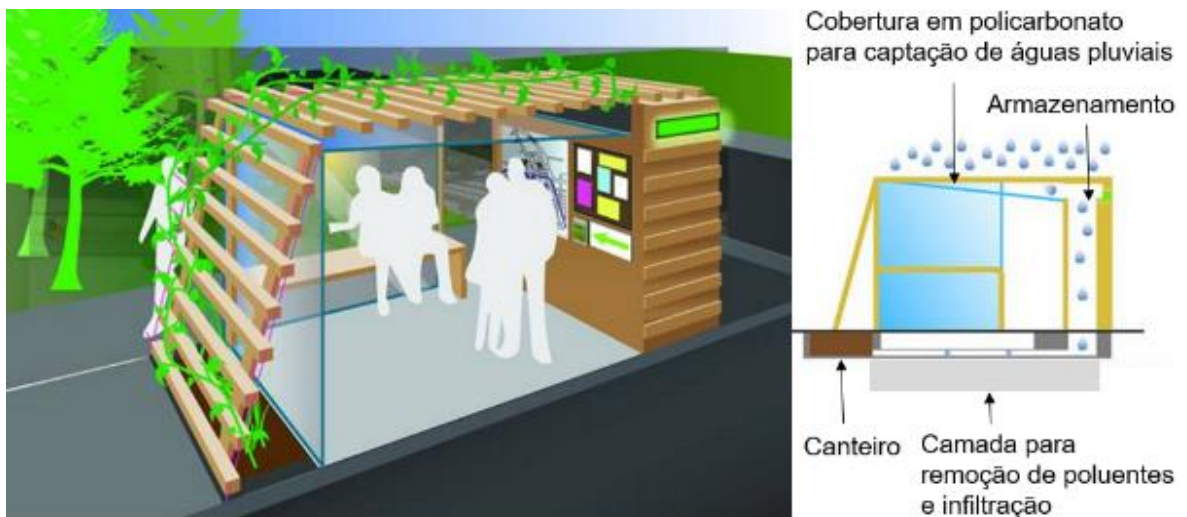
Proposta de equipamento urbano com teto inclinado para captação de águas pluviais, armazenamento lateral com camada subsuperficial - adsorção de poluentes e canteiro lateral para ajardinamento (Adaptado de Woehl, 2013).
